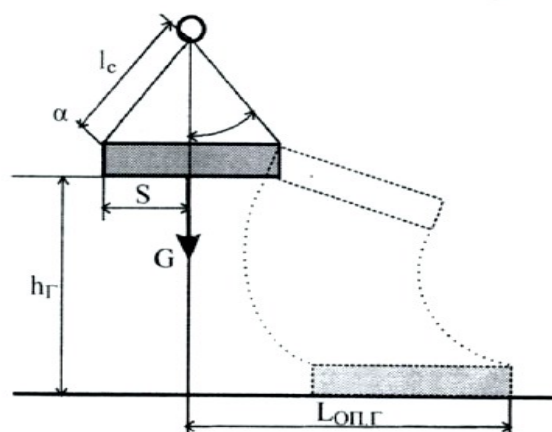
Схема определения границ опасной зоны при обрыве стропа грузоподъёмной машины
